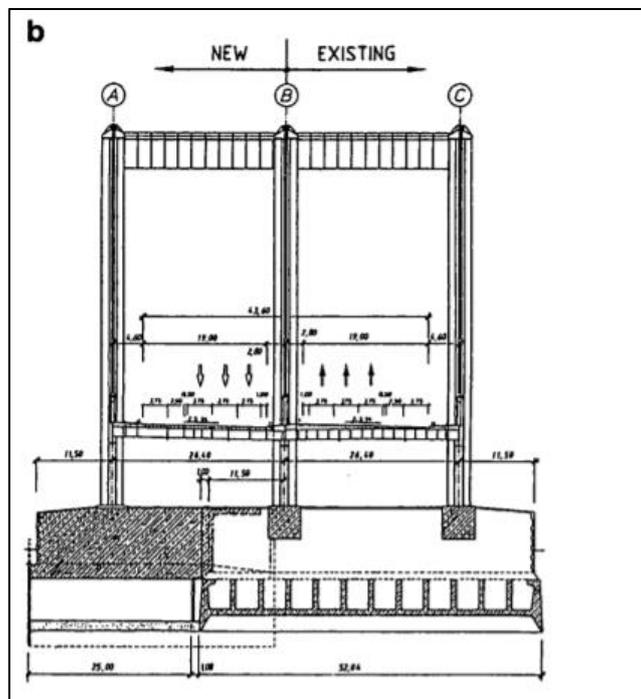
sección puente Köln-Rodenkirchen [3]
